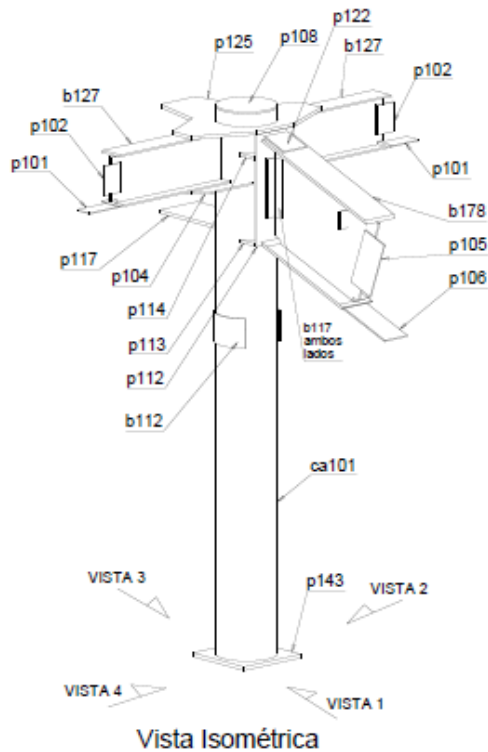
42. Columna de gradería P103 proyecto ANDE.
